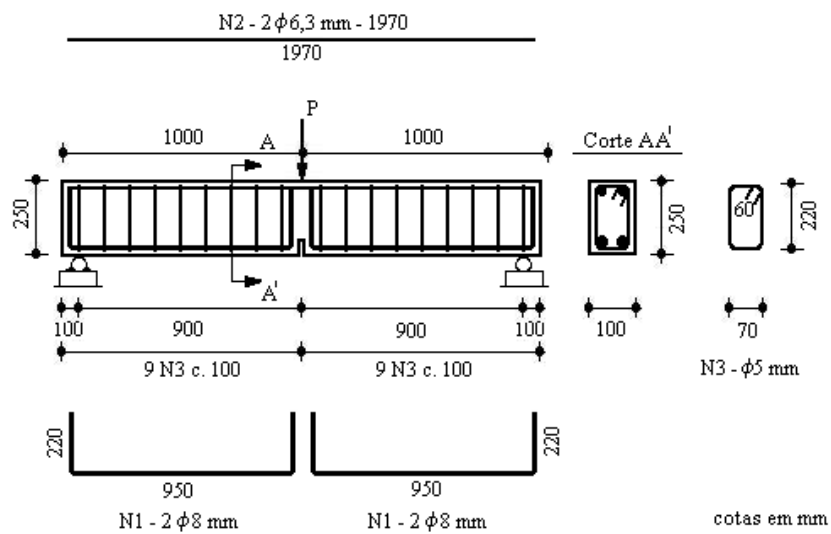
Armaduras Internas das Vigotas de Concreto Armado
